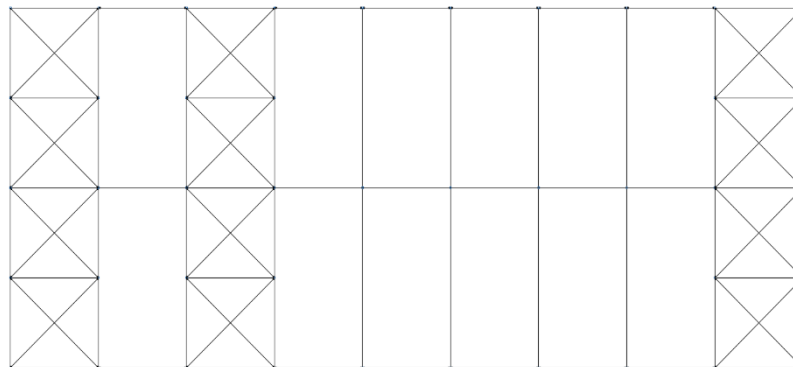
Cubierta nave secundaria
